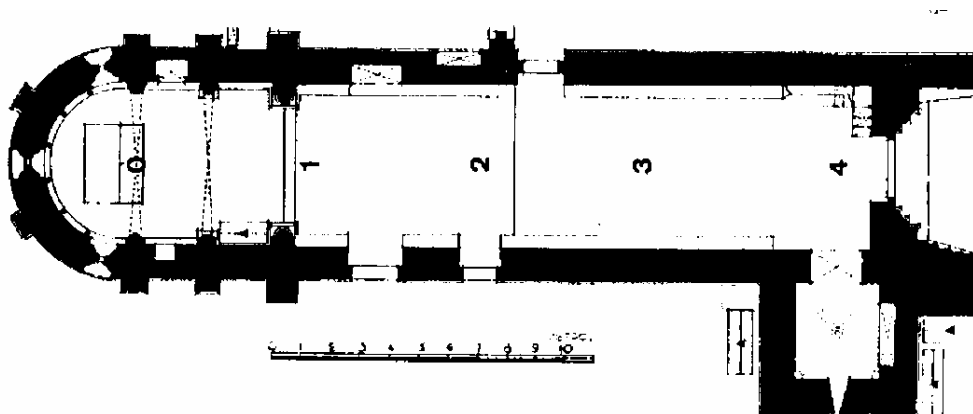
Planta da igreja de São Pedro de Cête [3]
